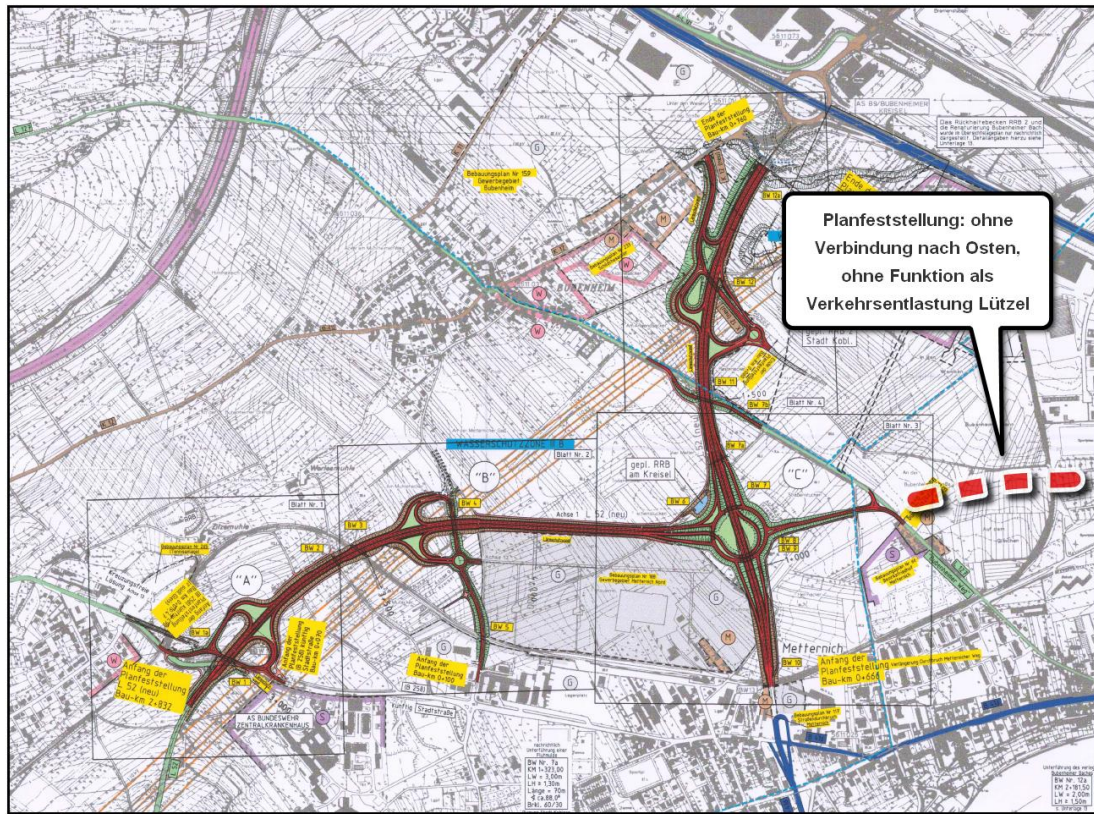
Übersichtsplan zur Planfeststellung Nordtangente 2004
